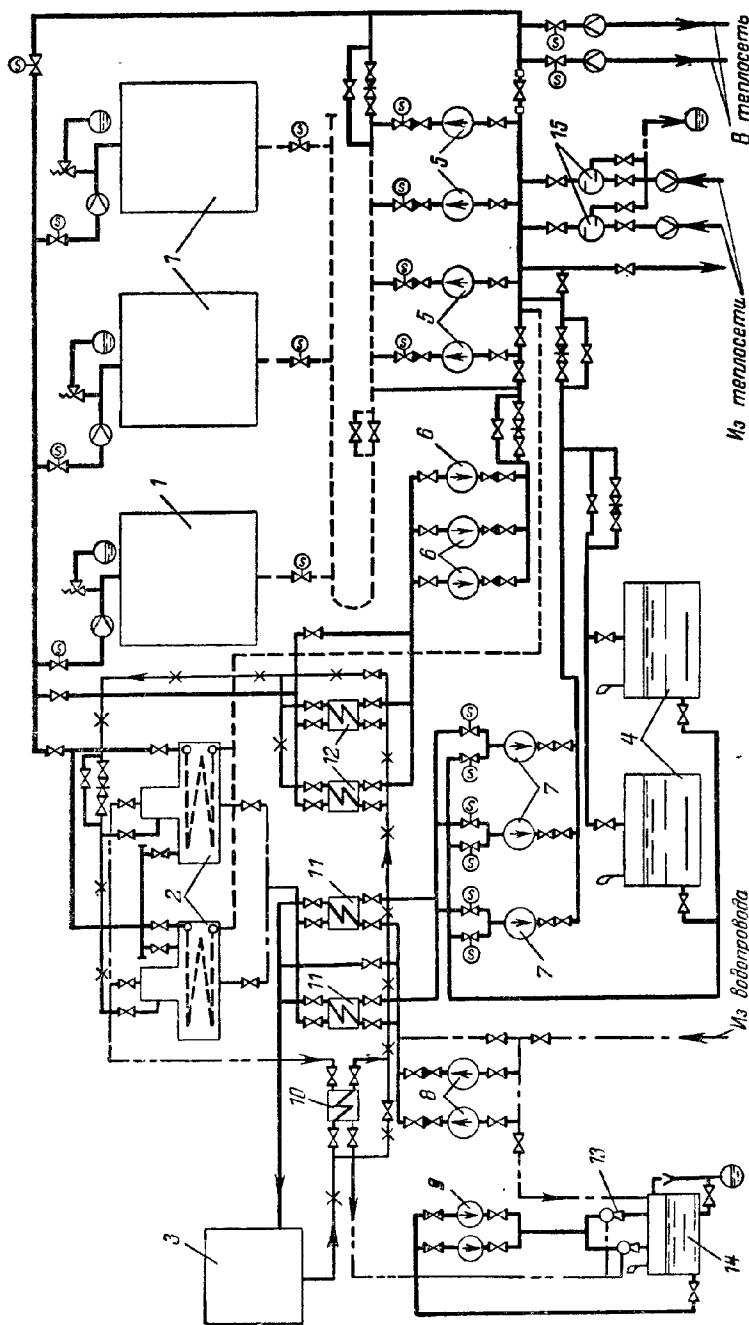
Пример тепловой схемы отопительной котельной со стальными водогрейными котлами и открытой схемой горячего водоснабжения.
